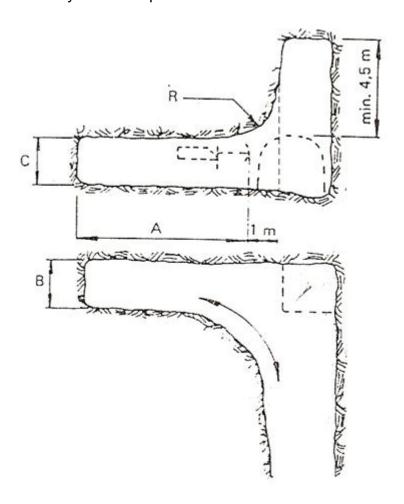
Diseño de cámara para chimeneas verticales
